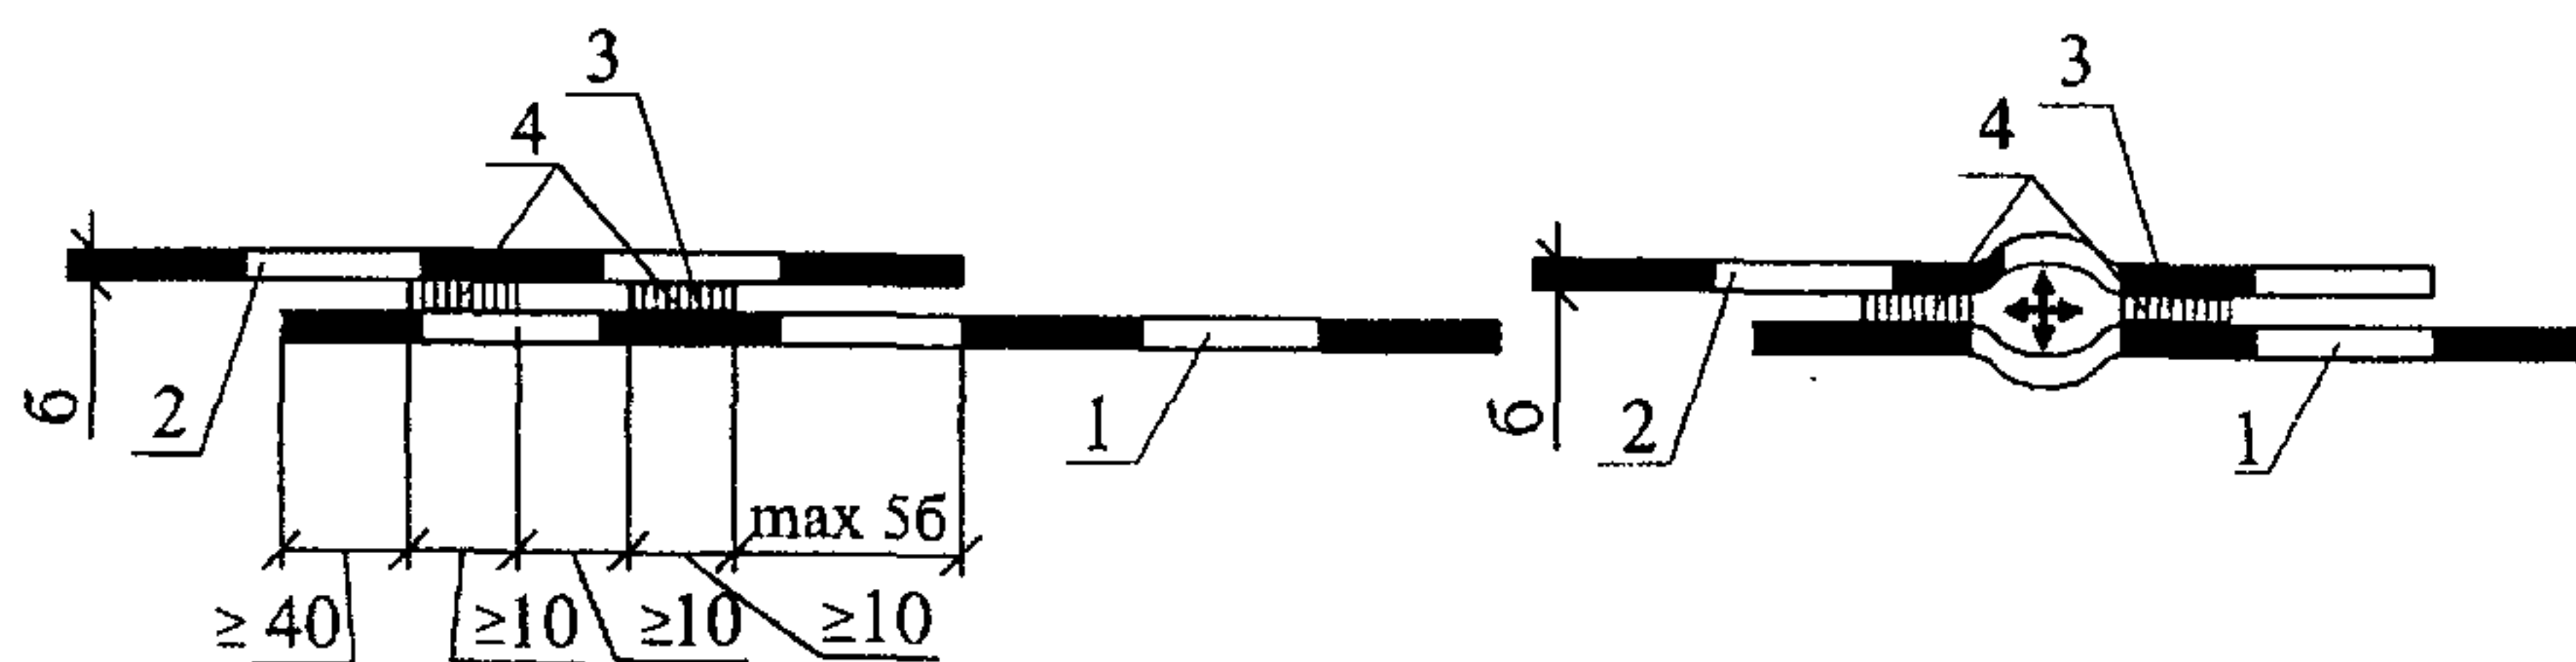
Испытание сварного шва с испытательным каналом
